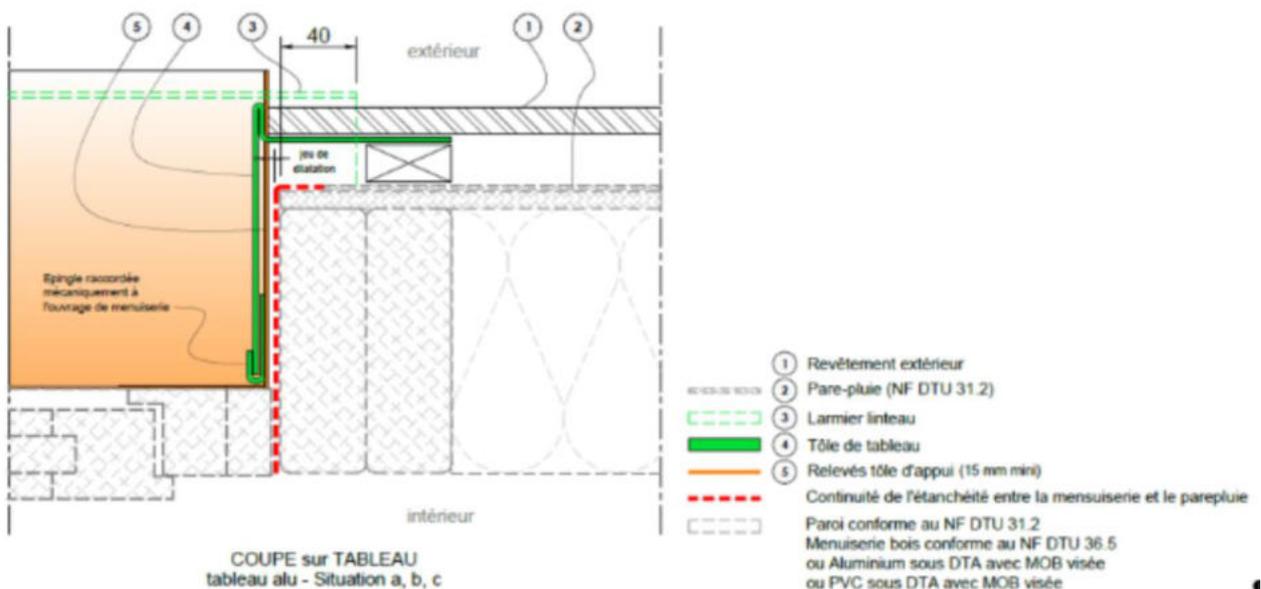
Pose sur COB- Coupe sur tableau de baie
